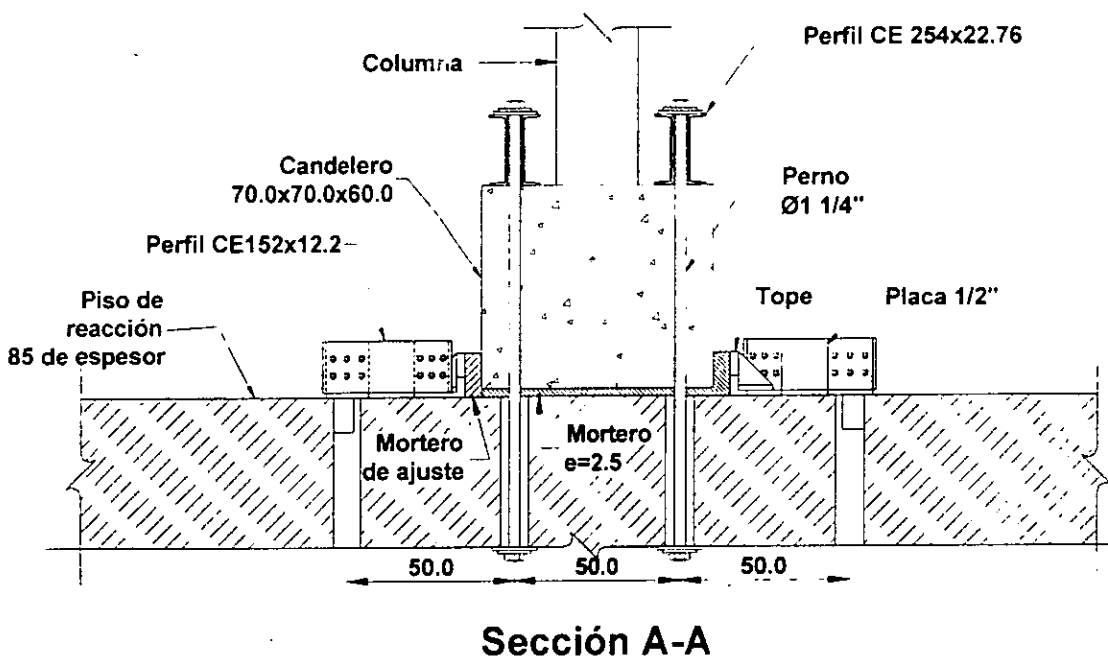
Detalles de fijación del espécimen. (dimensiones en centímetros, continuación)
